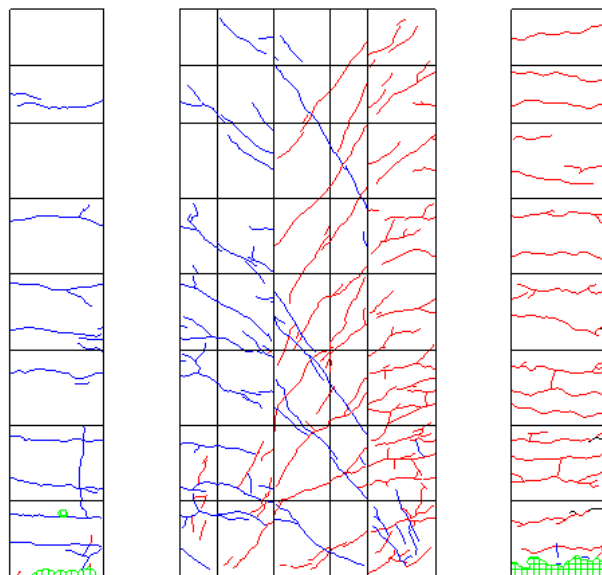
R=1/33②ひび割れ図
